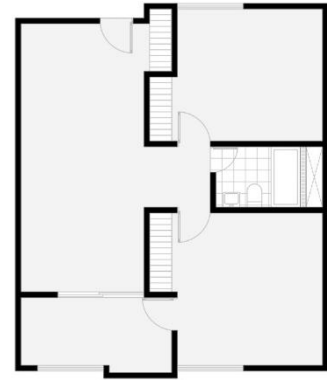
Tipología de vivienda. Fuente: Archdaily
